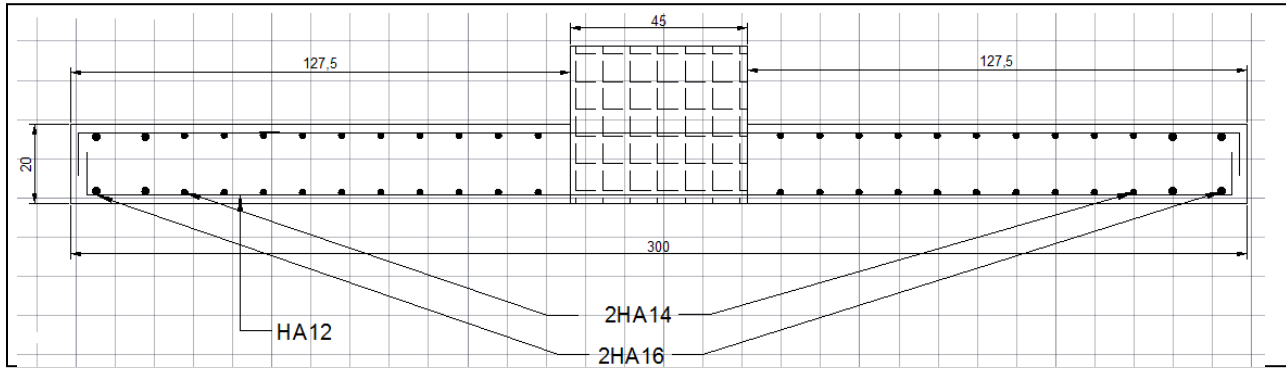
ferrailage du voile V_{X-x1} er Etage
